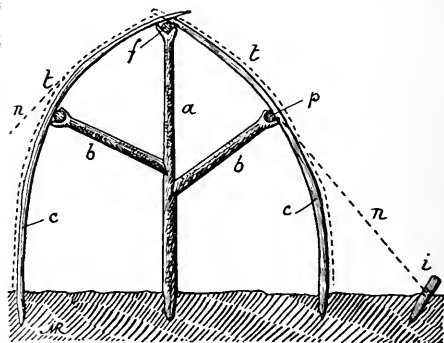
Coupe transversale d'une tente (essai de restauration).
